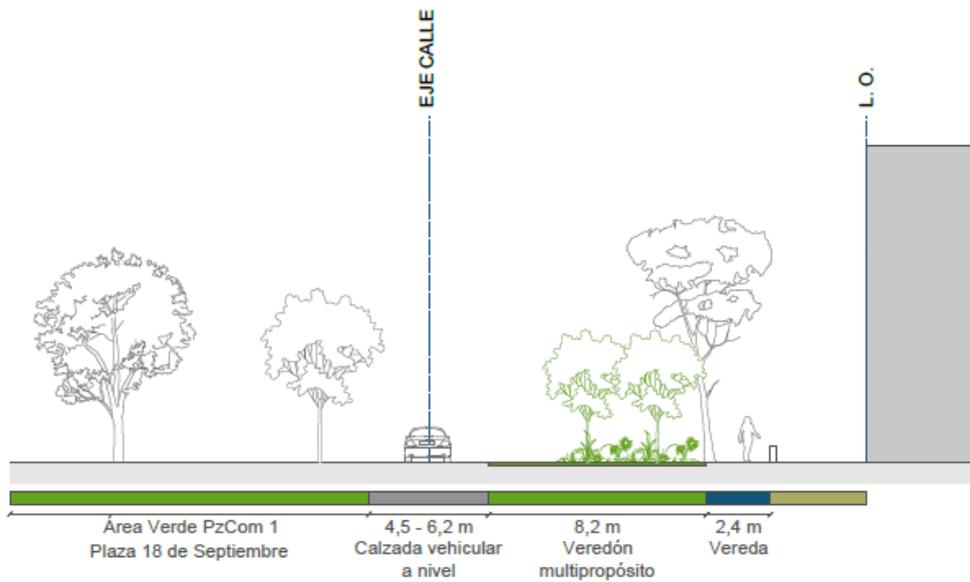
Perfil D-D'. Situación propuesta plaza 18 de Septiembre.
